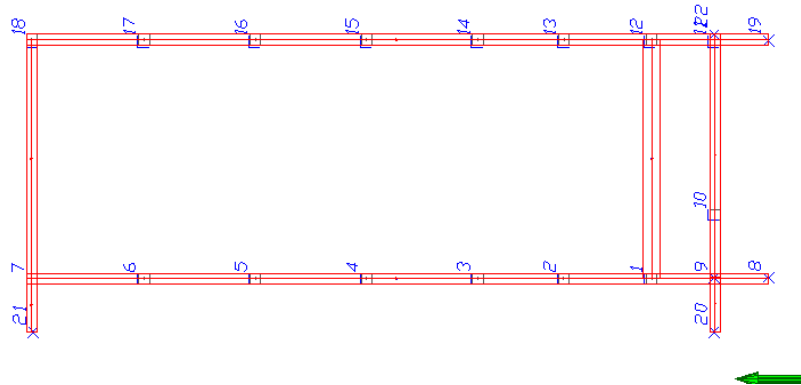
1 - Pianta chiave numerazione travi e pilastri.
